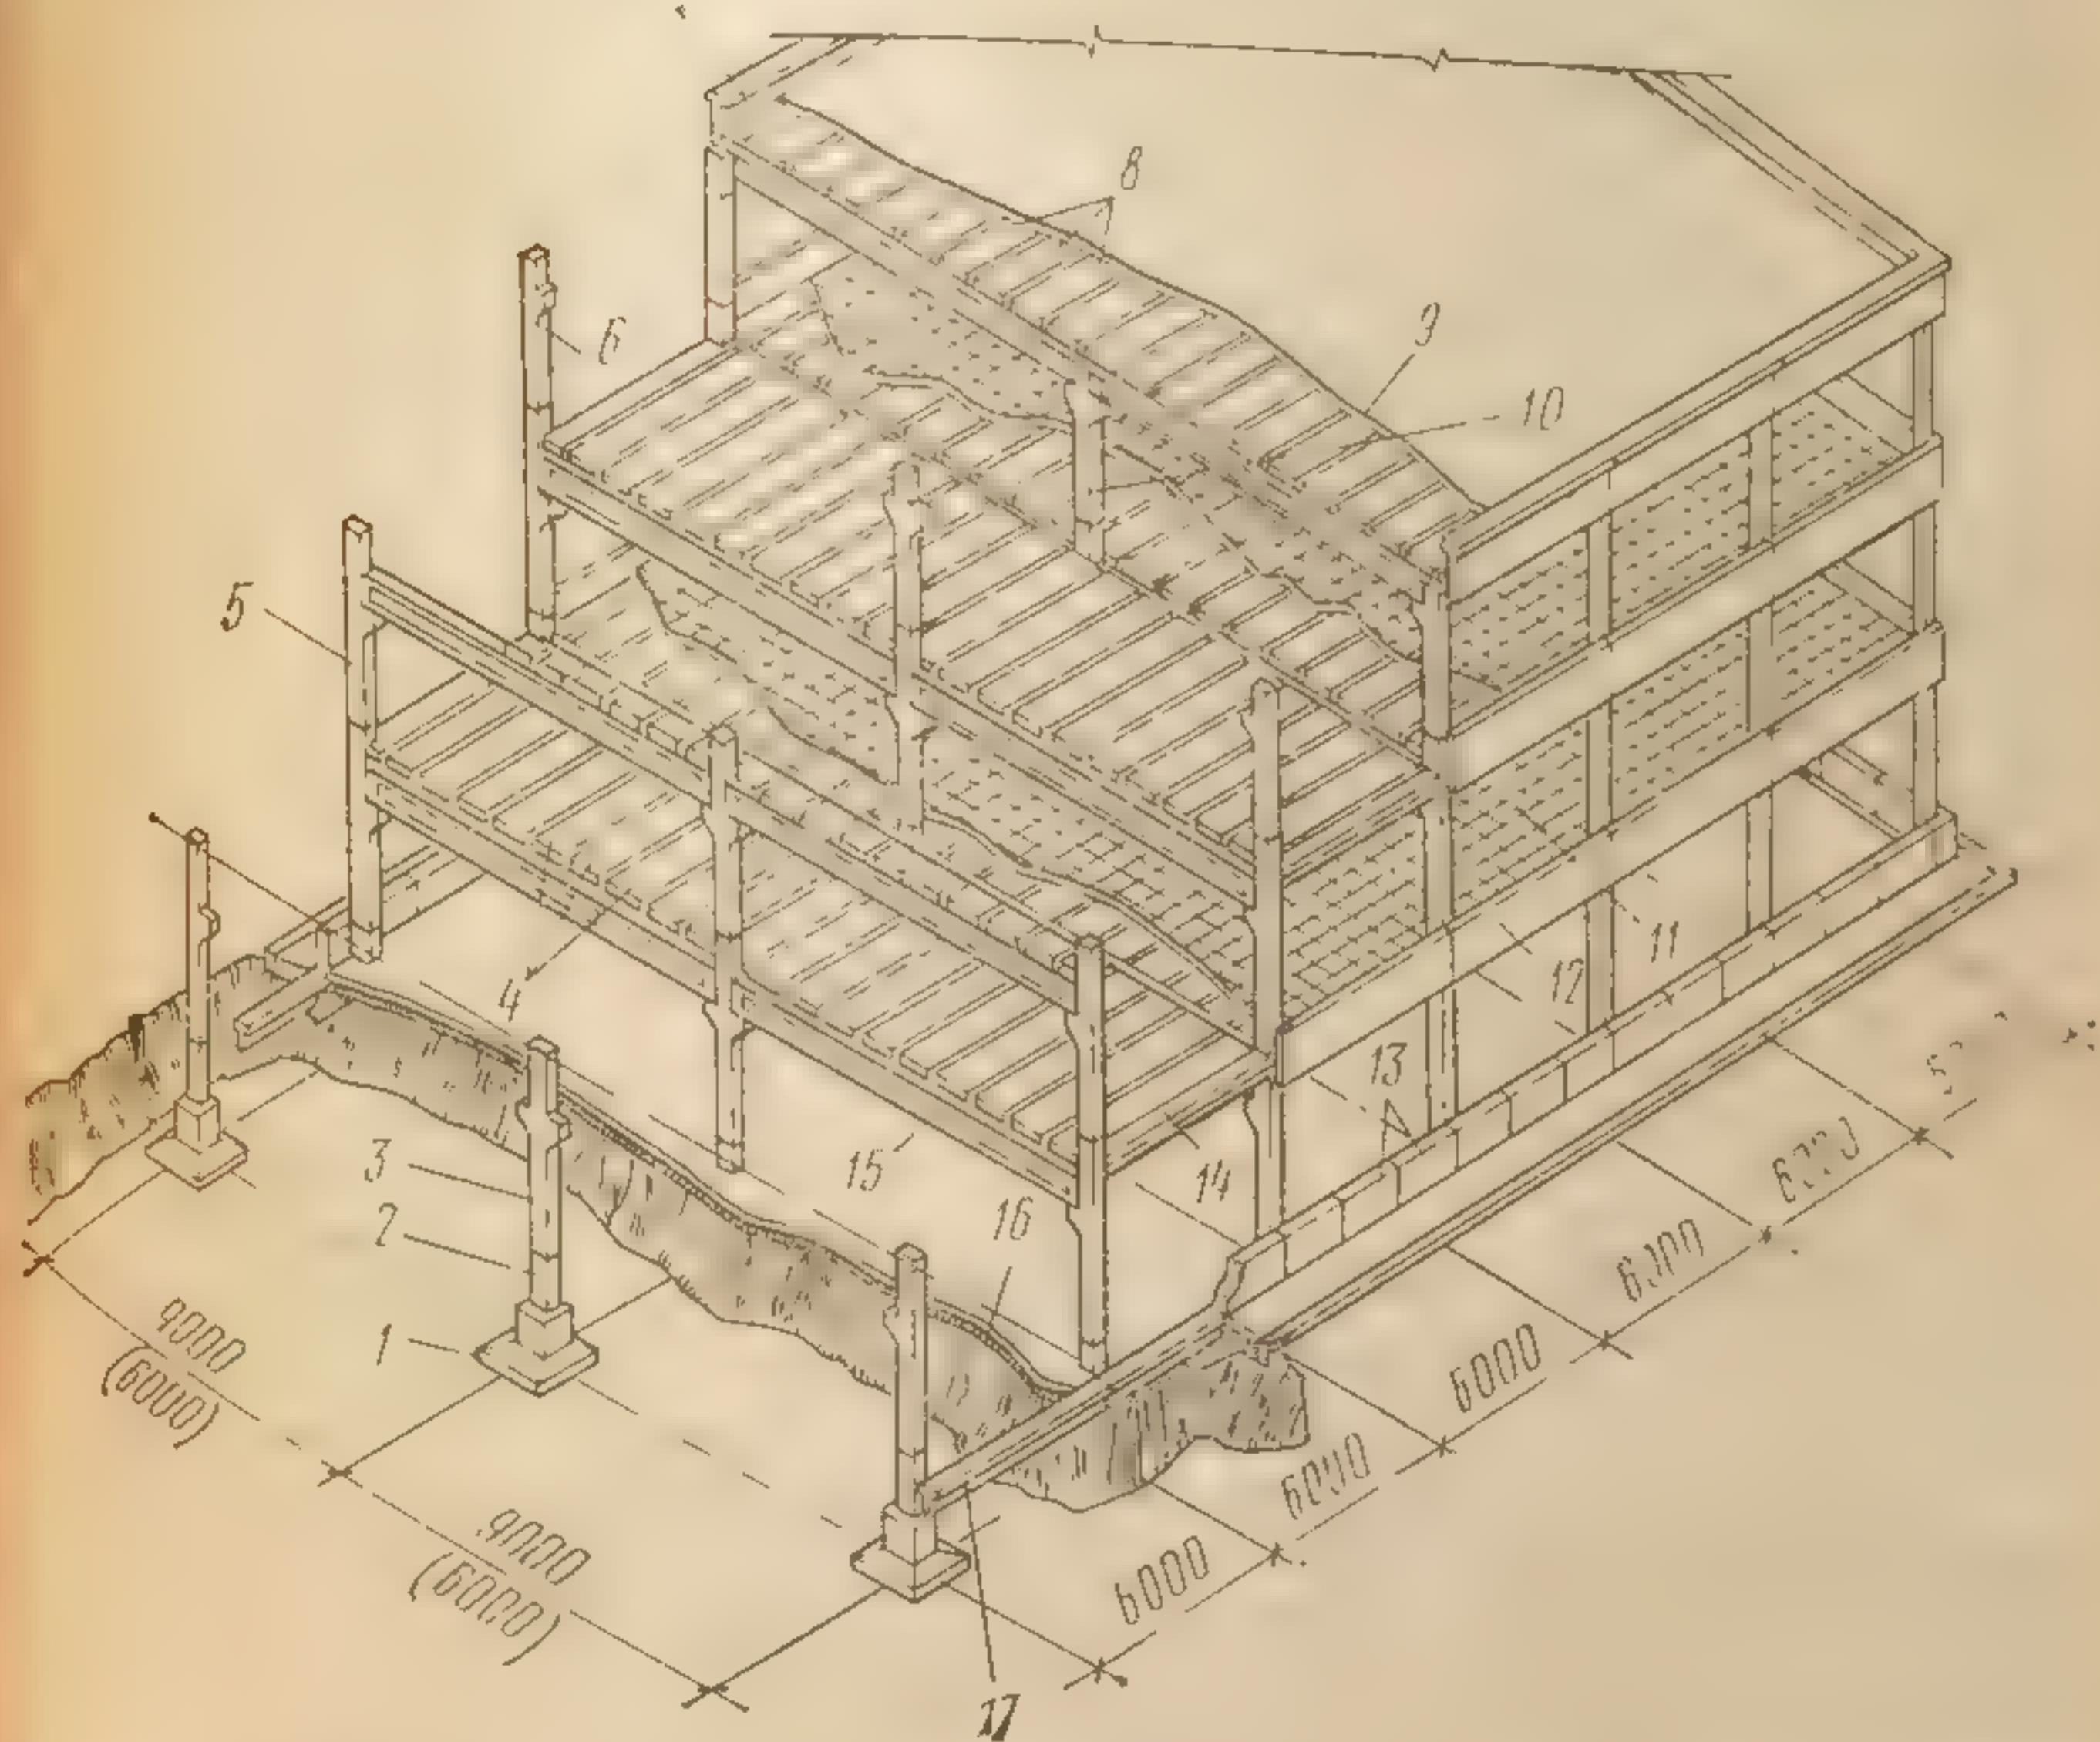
Конструкция многоэтажного промышленного здания с железобетонным каркасом:
